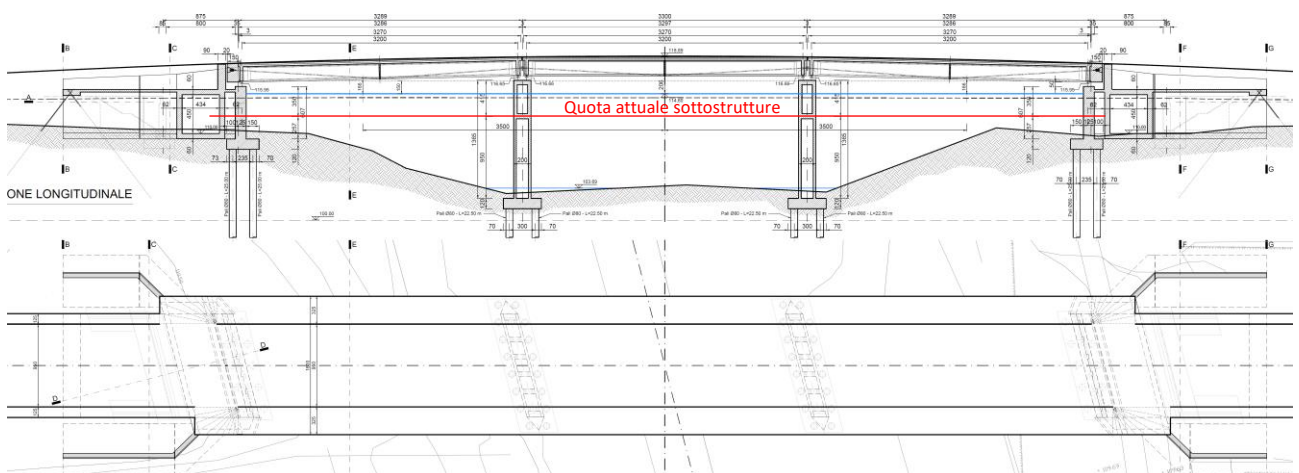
Profilo longitudinale e planimetria stato di progetto
